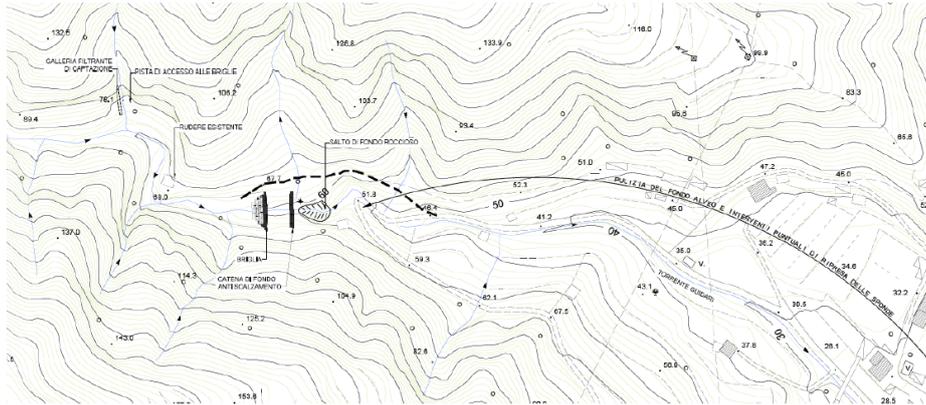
Estratto della planimetria di progetto con l'ubicazione della briglia di sistemazione dell'asta.
